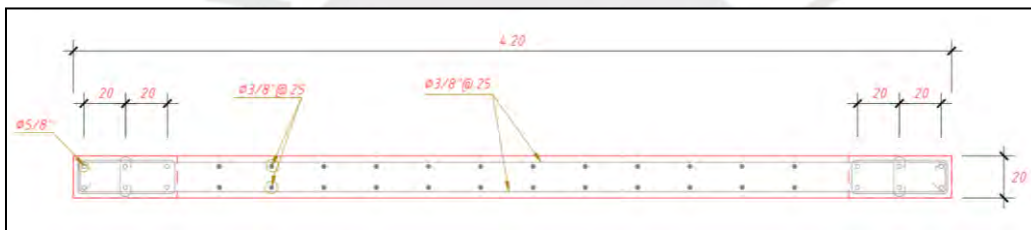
SECCIÓN PROPUESTA DE LA PLACA PL-04.
